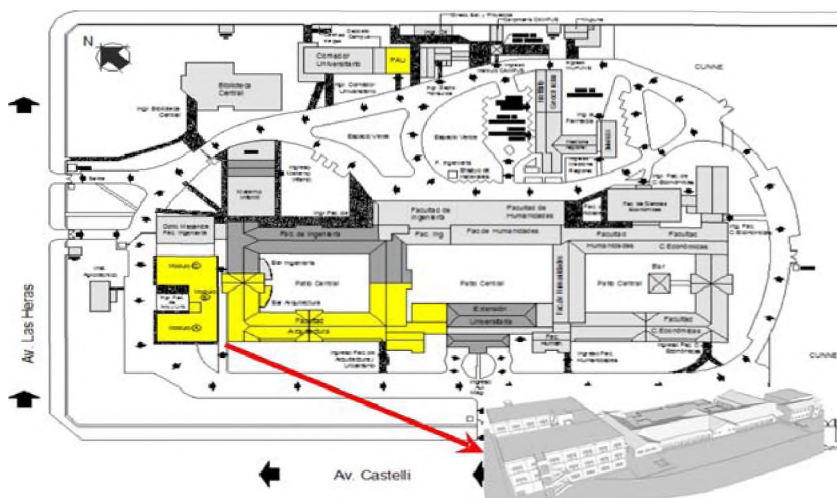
Planimetría Campus UNNE, Resistencia - Facultad de Arquitectura (en amarillo)
